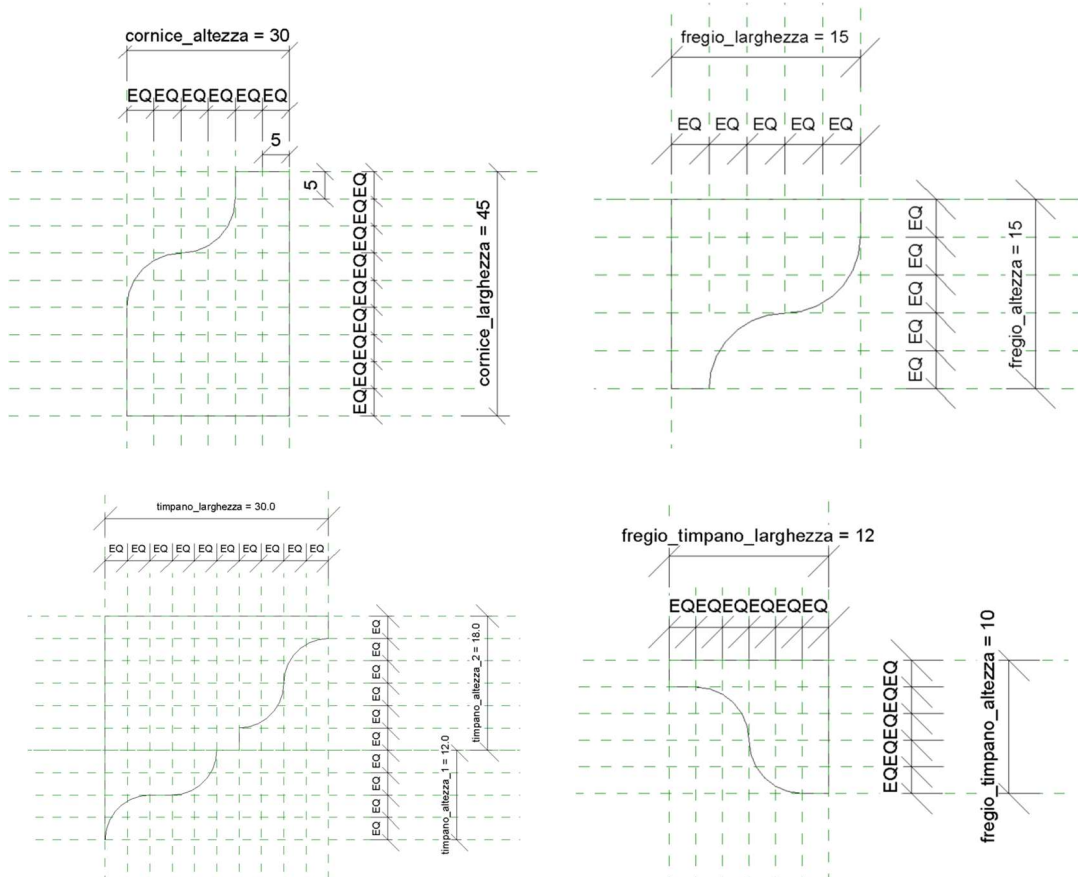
Costruzione dei profili su Revit utilizzati per l'apparato decorativo (Fonte: elaborato dall'autore)
